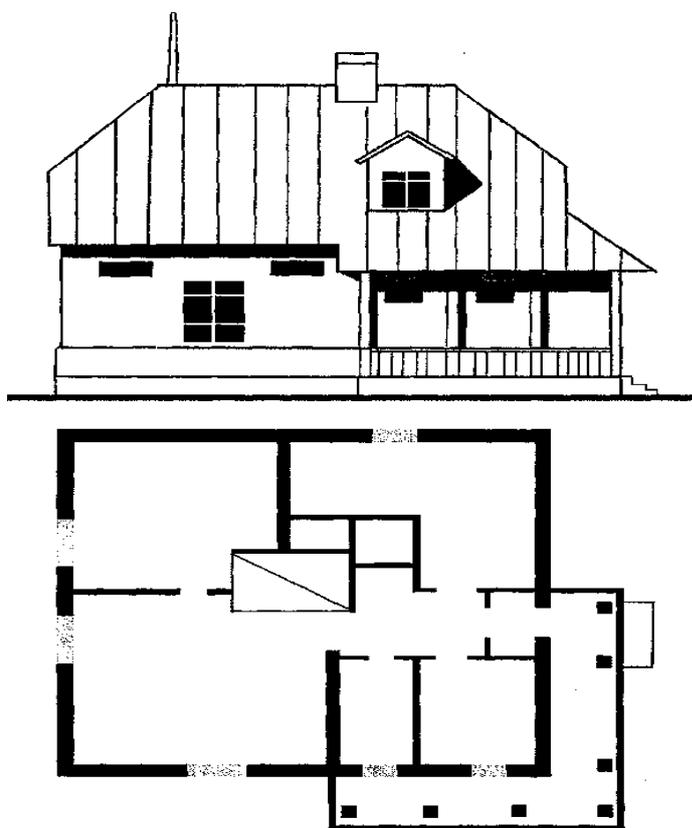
Проект двухкомнатного жилого дома колхозника с печным отоплением и хозяйственными кладовыми. 1936 г. Фасад, план
